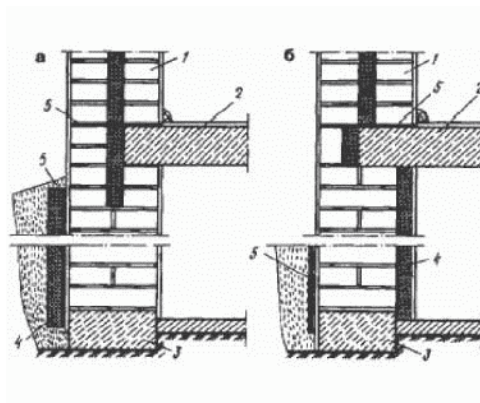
Утепление стен подвала пенополистиролом с наружной (а) и внутренней (б) стороны
